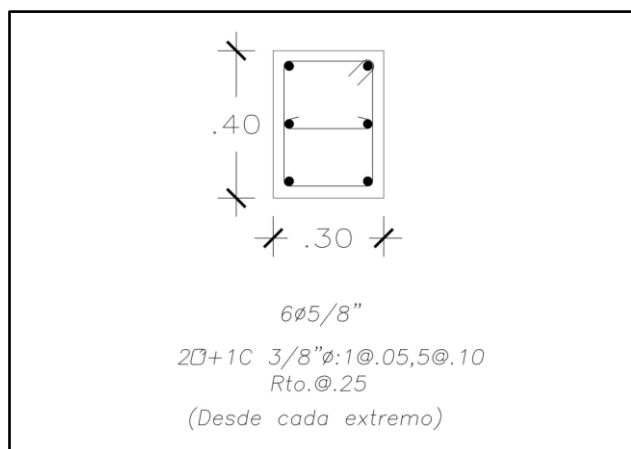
Armado de acero de la columna C-3 (0.30x0.40m)
